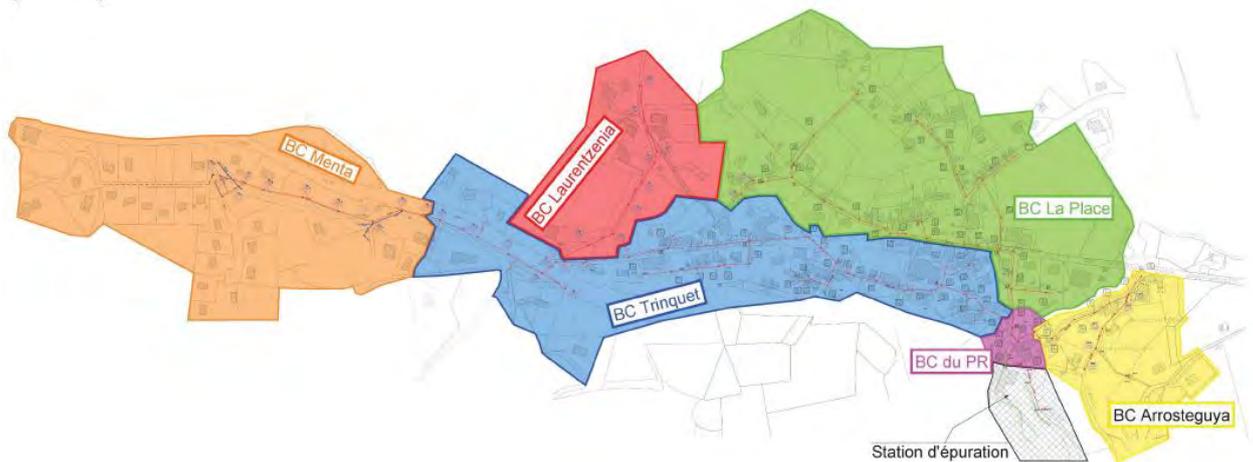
Plan du système de collecte des eaux usées de Louhossoa
